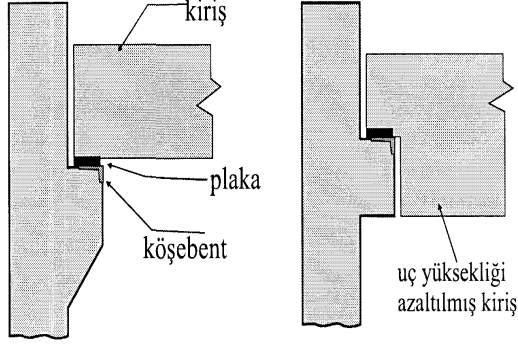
Prefabrik kiriş, kolon ve konsol elemanlar
